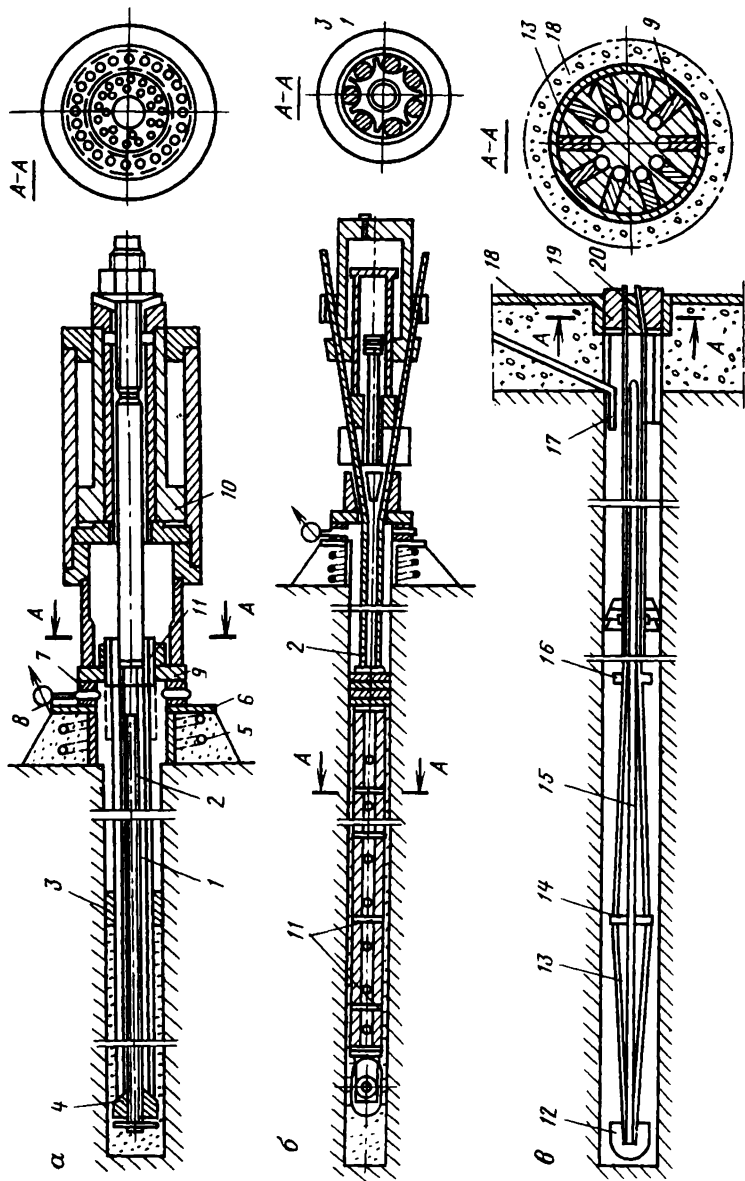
Железобетонные анкеры с прутковой арматурой
